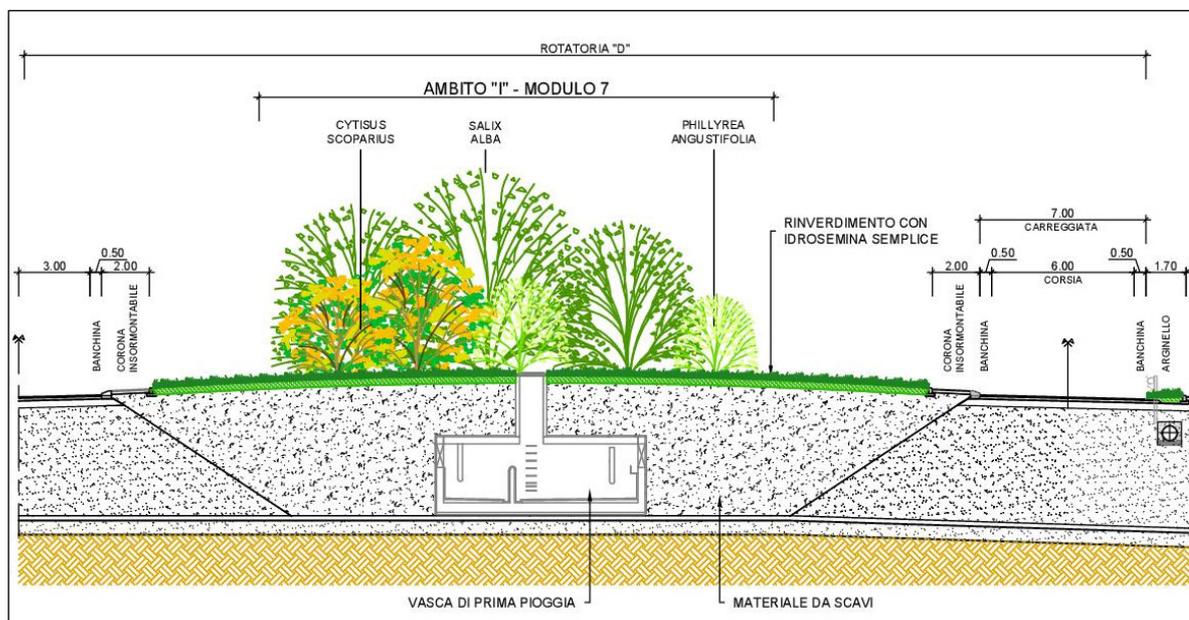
Stralcio planimetrico e sezione, Ambito I, Modulo 7 – Rotatoria I
